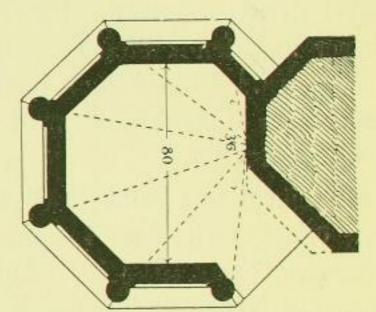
Göda, Kirche, Kanzel, Grundriß.
